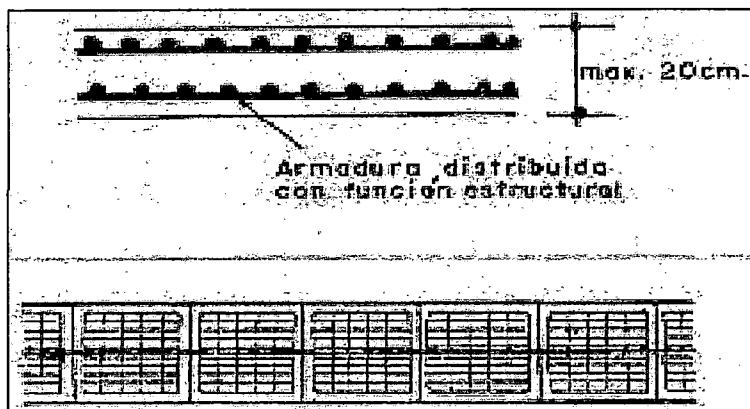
Sección del pavimento con refuerzo de acero estructural
